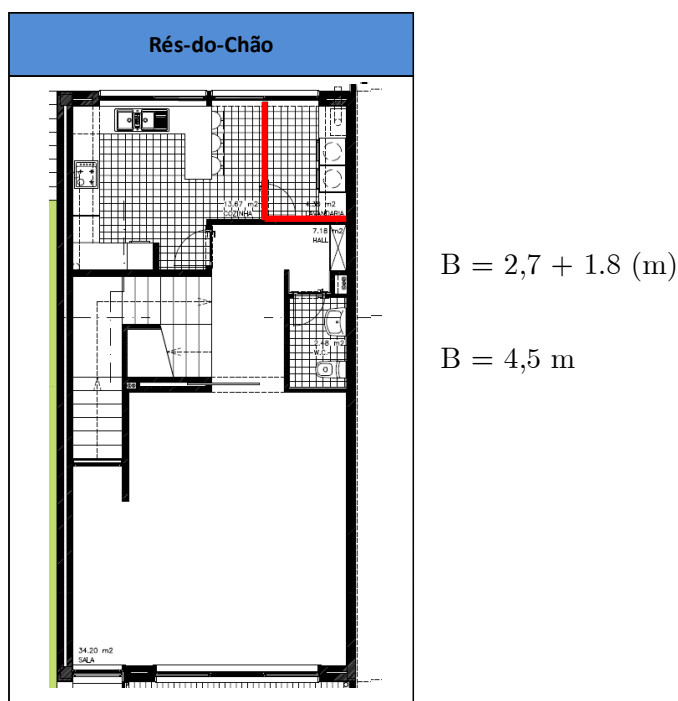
Ponte térmica linear de parede de lavanderia com pavimento.
